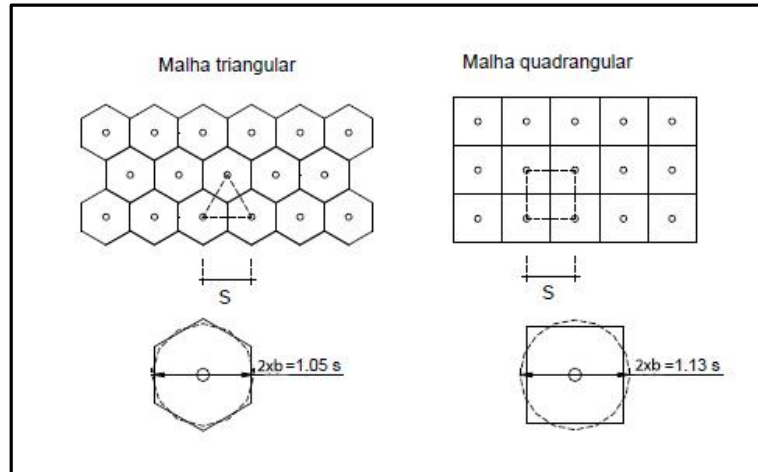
Diferentes distribuições em planta de colunas de brita, adaptado de [26].
